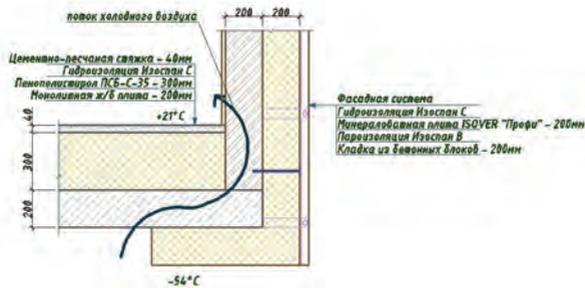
узел утепления с частичным утеплением снизу в стыке цокольного перекрытия с наружной стеной.
